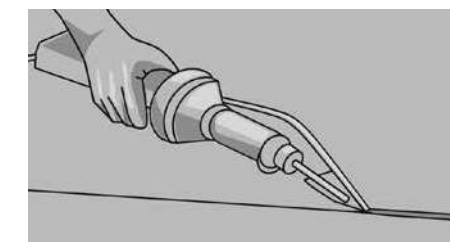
Сделайте горячую сварку с помощью сварочной насадки. Сварку можно производить через 24 часа после приклеивания
